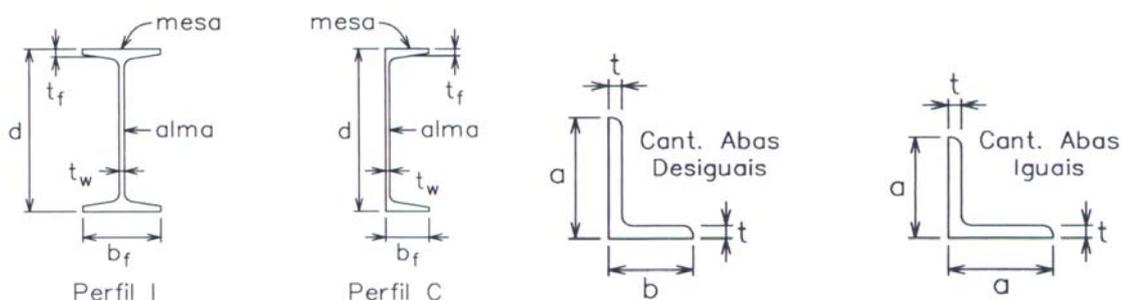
Perfis laminados e cantoneiras laminadas – padrão americano.
